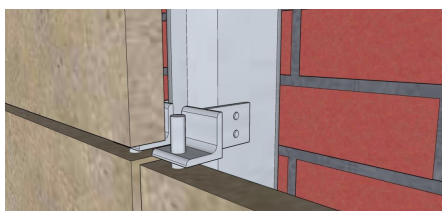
Subestrutura de apoio de placas - Ancoragem por grampos. Fachada ventilada.
